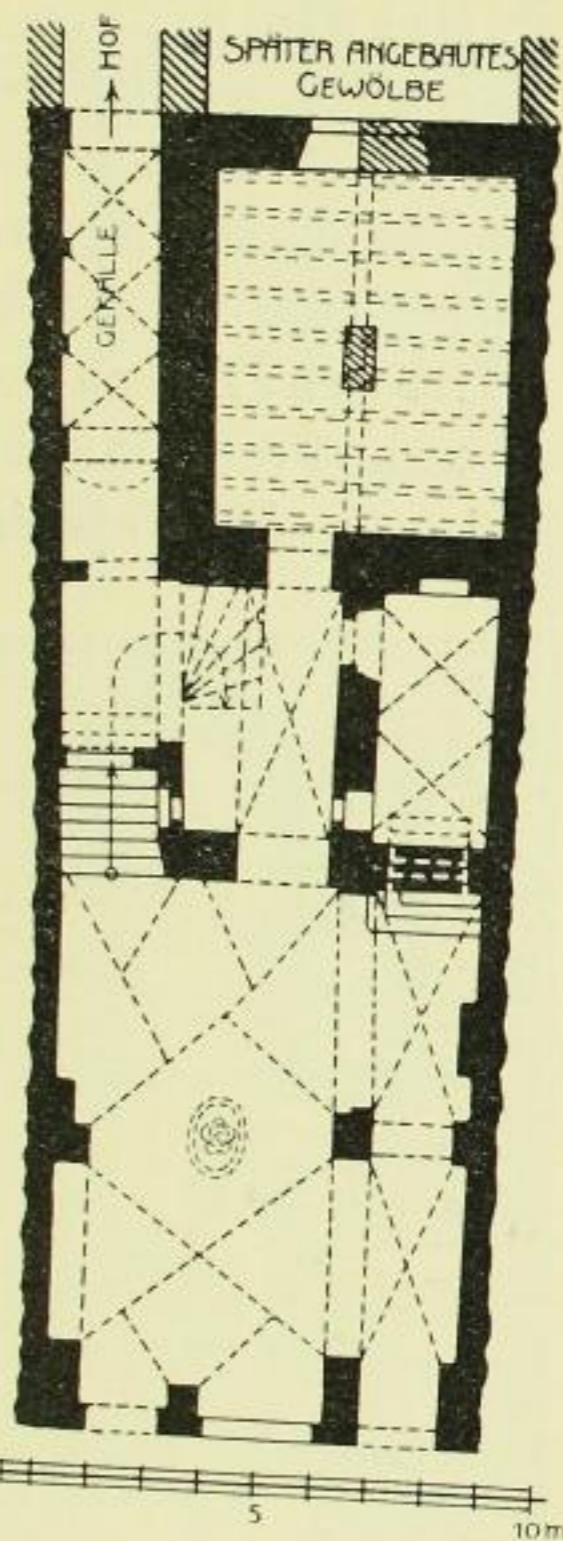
Reichenstraße Nr. 2, Erdgeschoß.
